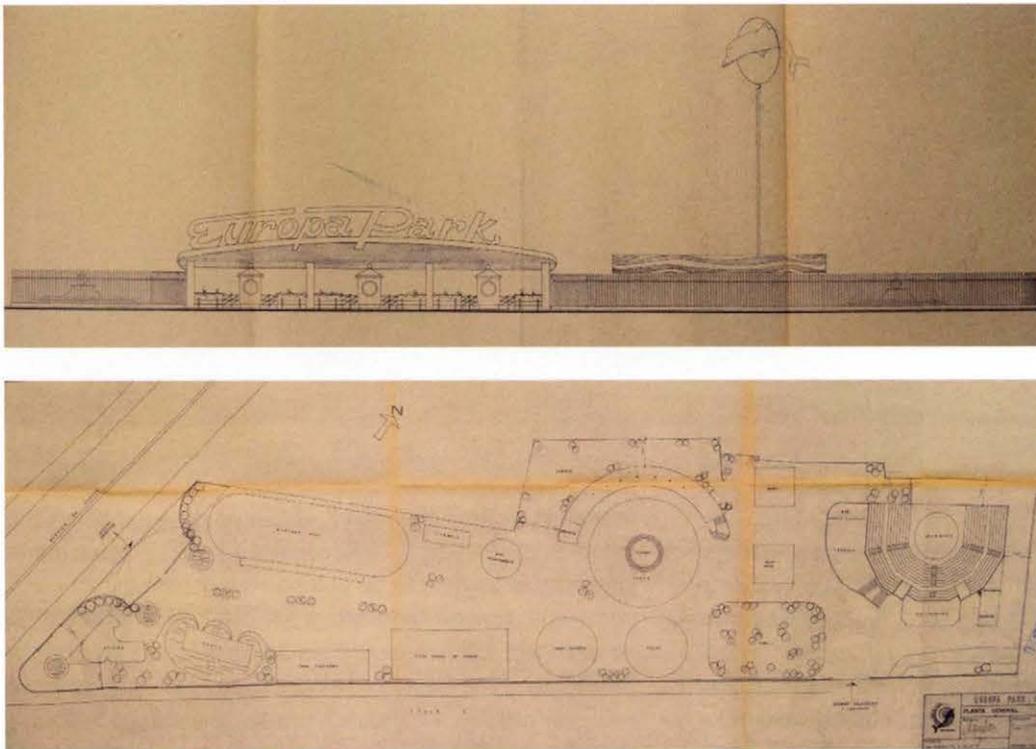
Parque de atracciones Europa Park, 1977, Benidorm, A. del Rey Sancho, planta del conjunto y fachada de acceso [Archivo Municipal de Benidorm].
